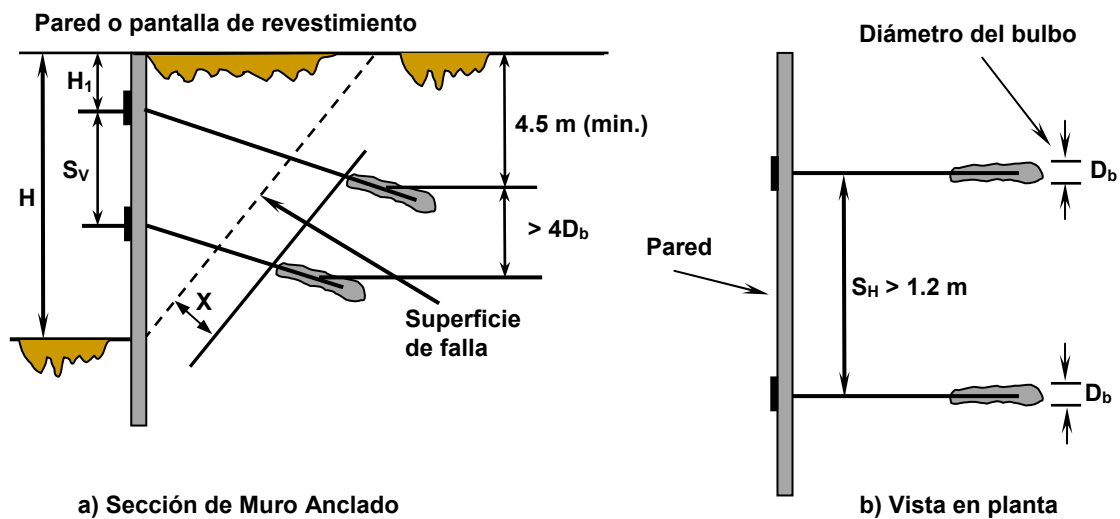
Espaciamiento mínimo entre anclajes en el muro anclado.
